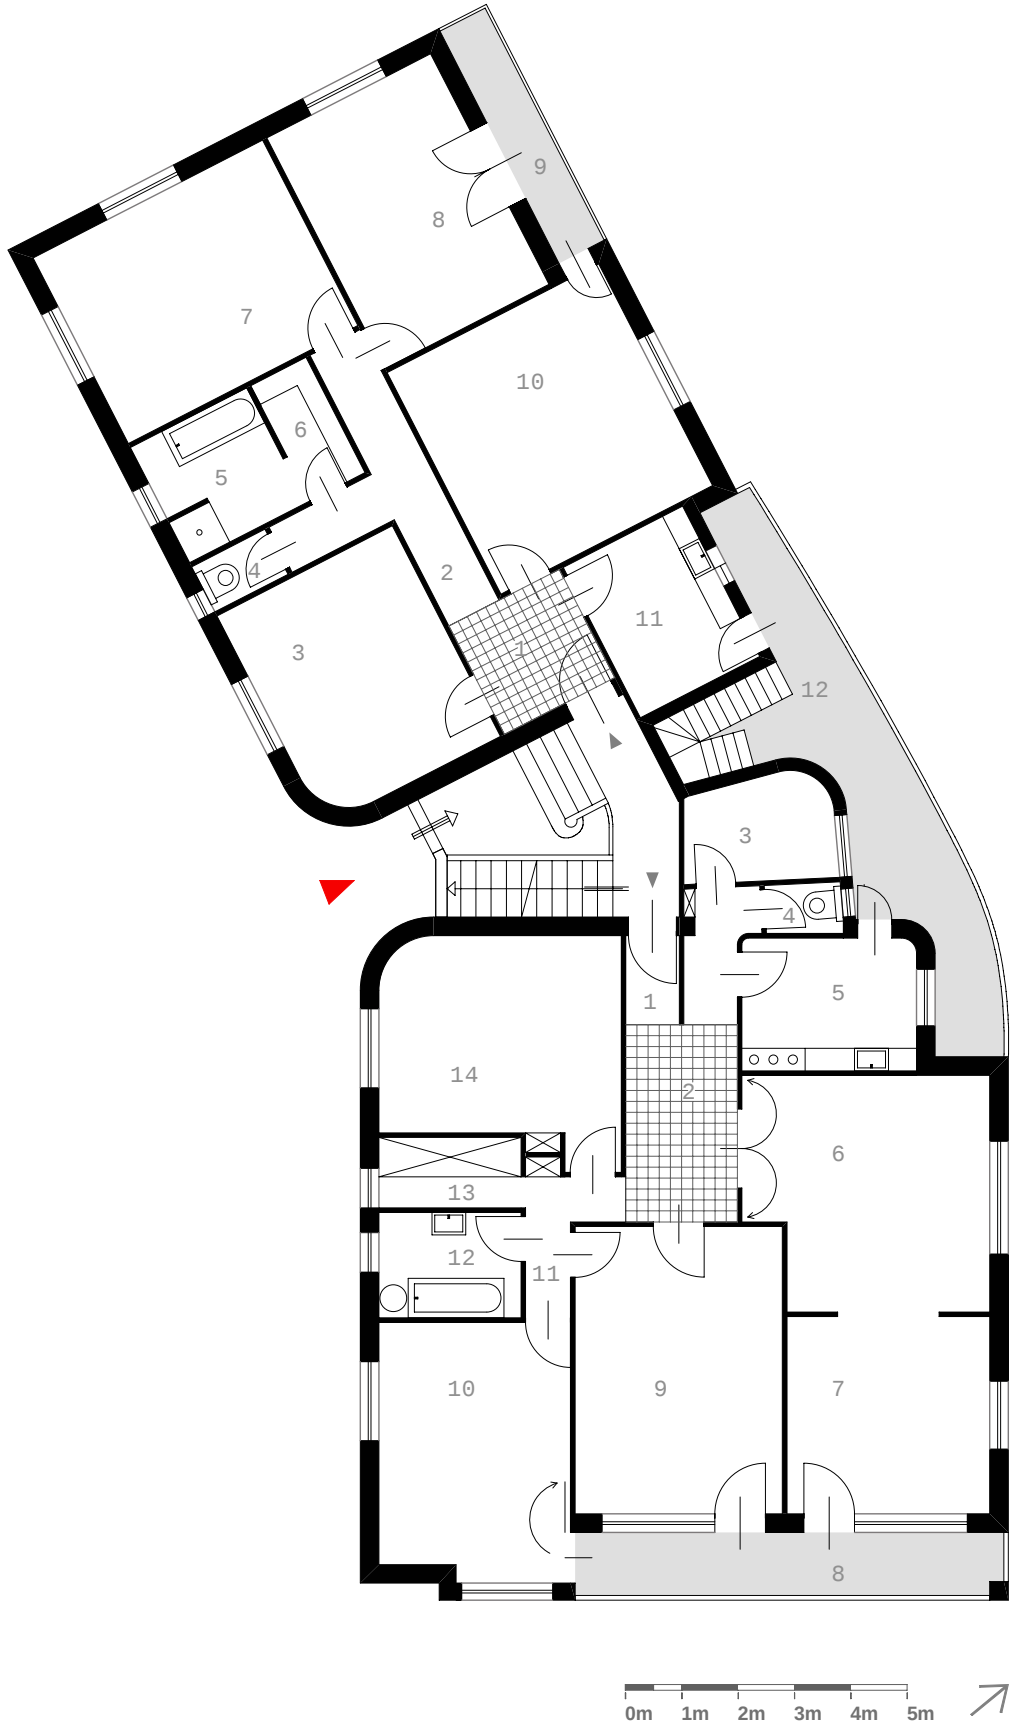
Grundriss Erdgeschoß. Gezeichnet von Nina Tatschl nach Originalplänen von 1932.
